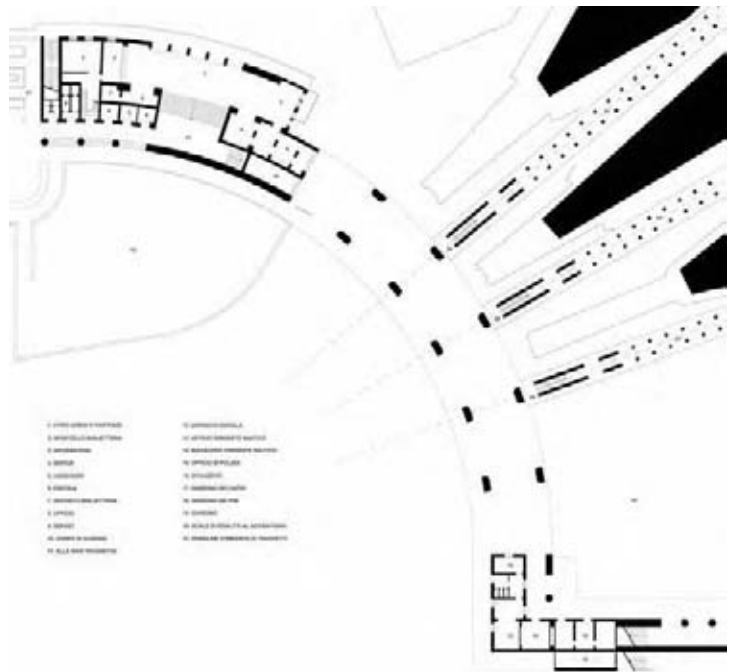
Stazione marittima, Messina, progetto di restauro, pianta del pianoterra
